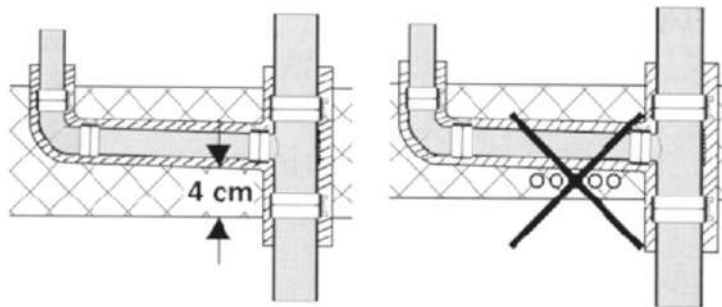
Posa delle tubazione nel calcestruzzo.
